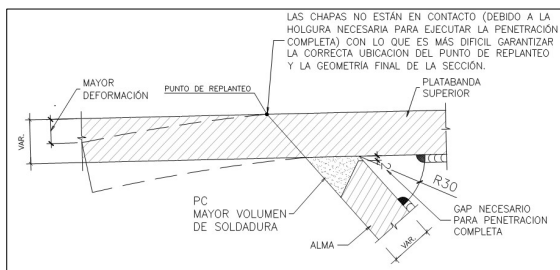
Ejemplo típico con soldadura de penetración completa.
